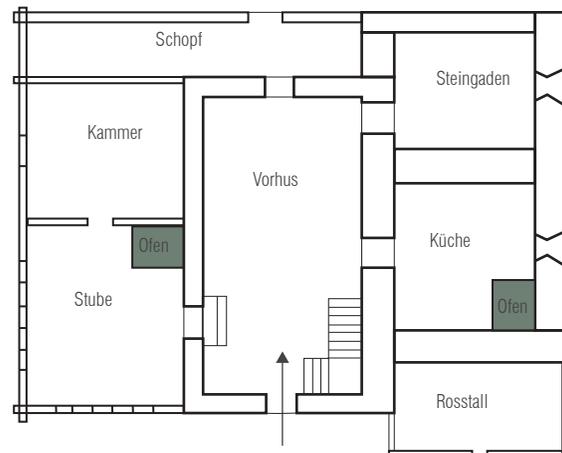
Grundriss Lech Oberstubenbach 29
